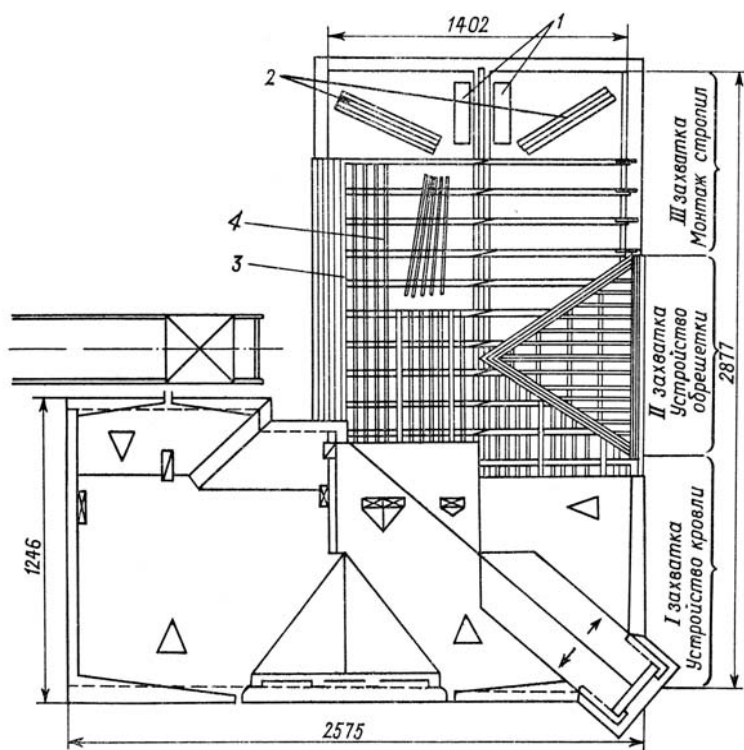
Общая схема организации работ по устройству стропильной системы из бревен с обрешеткой из брусков:
